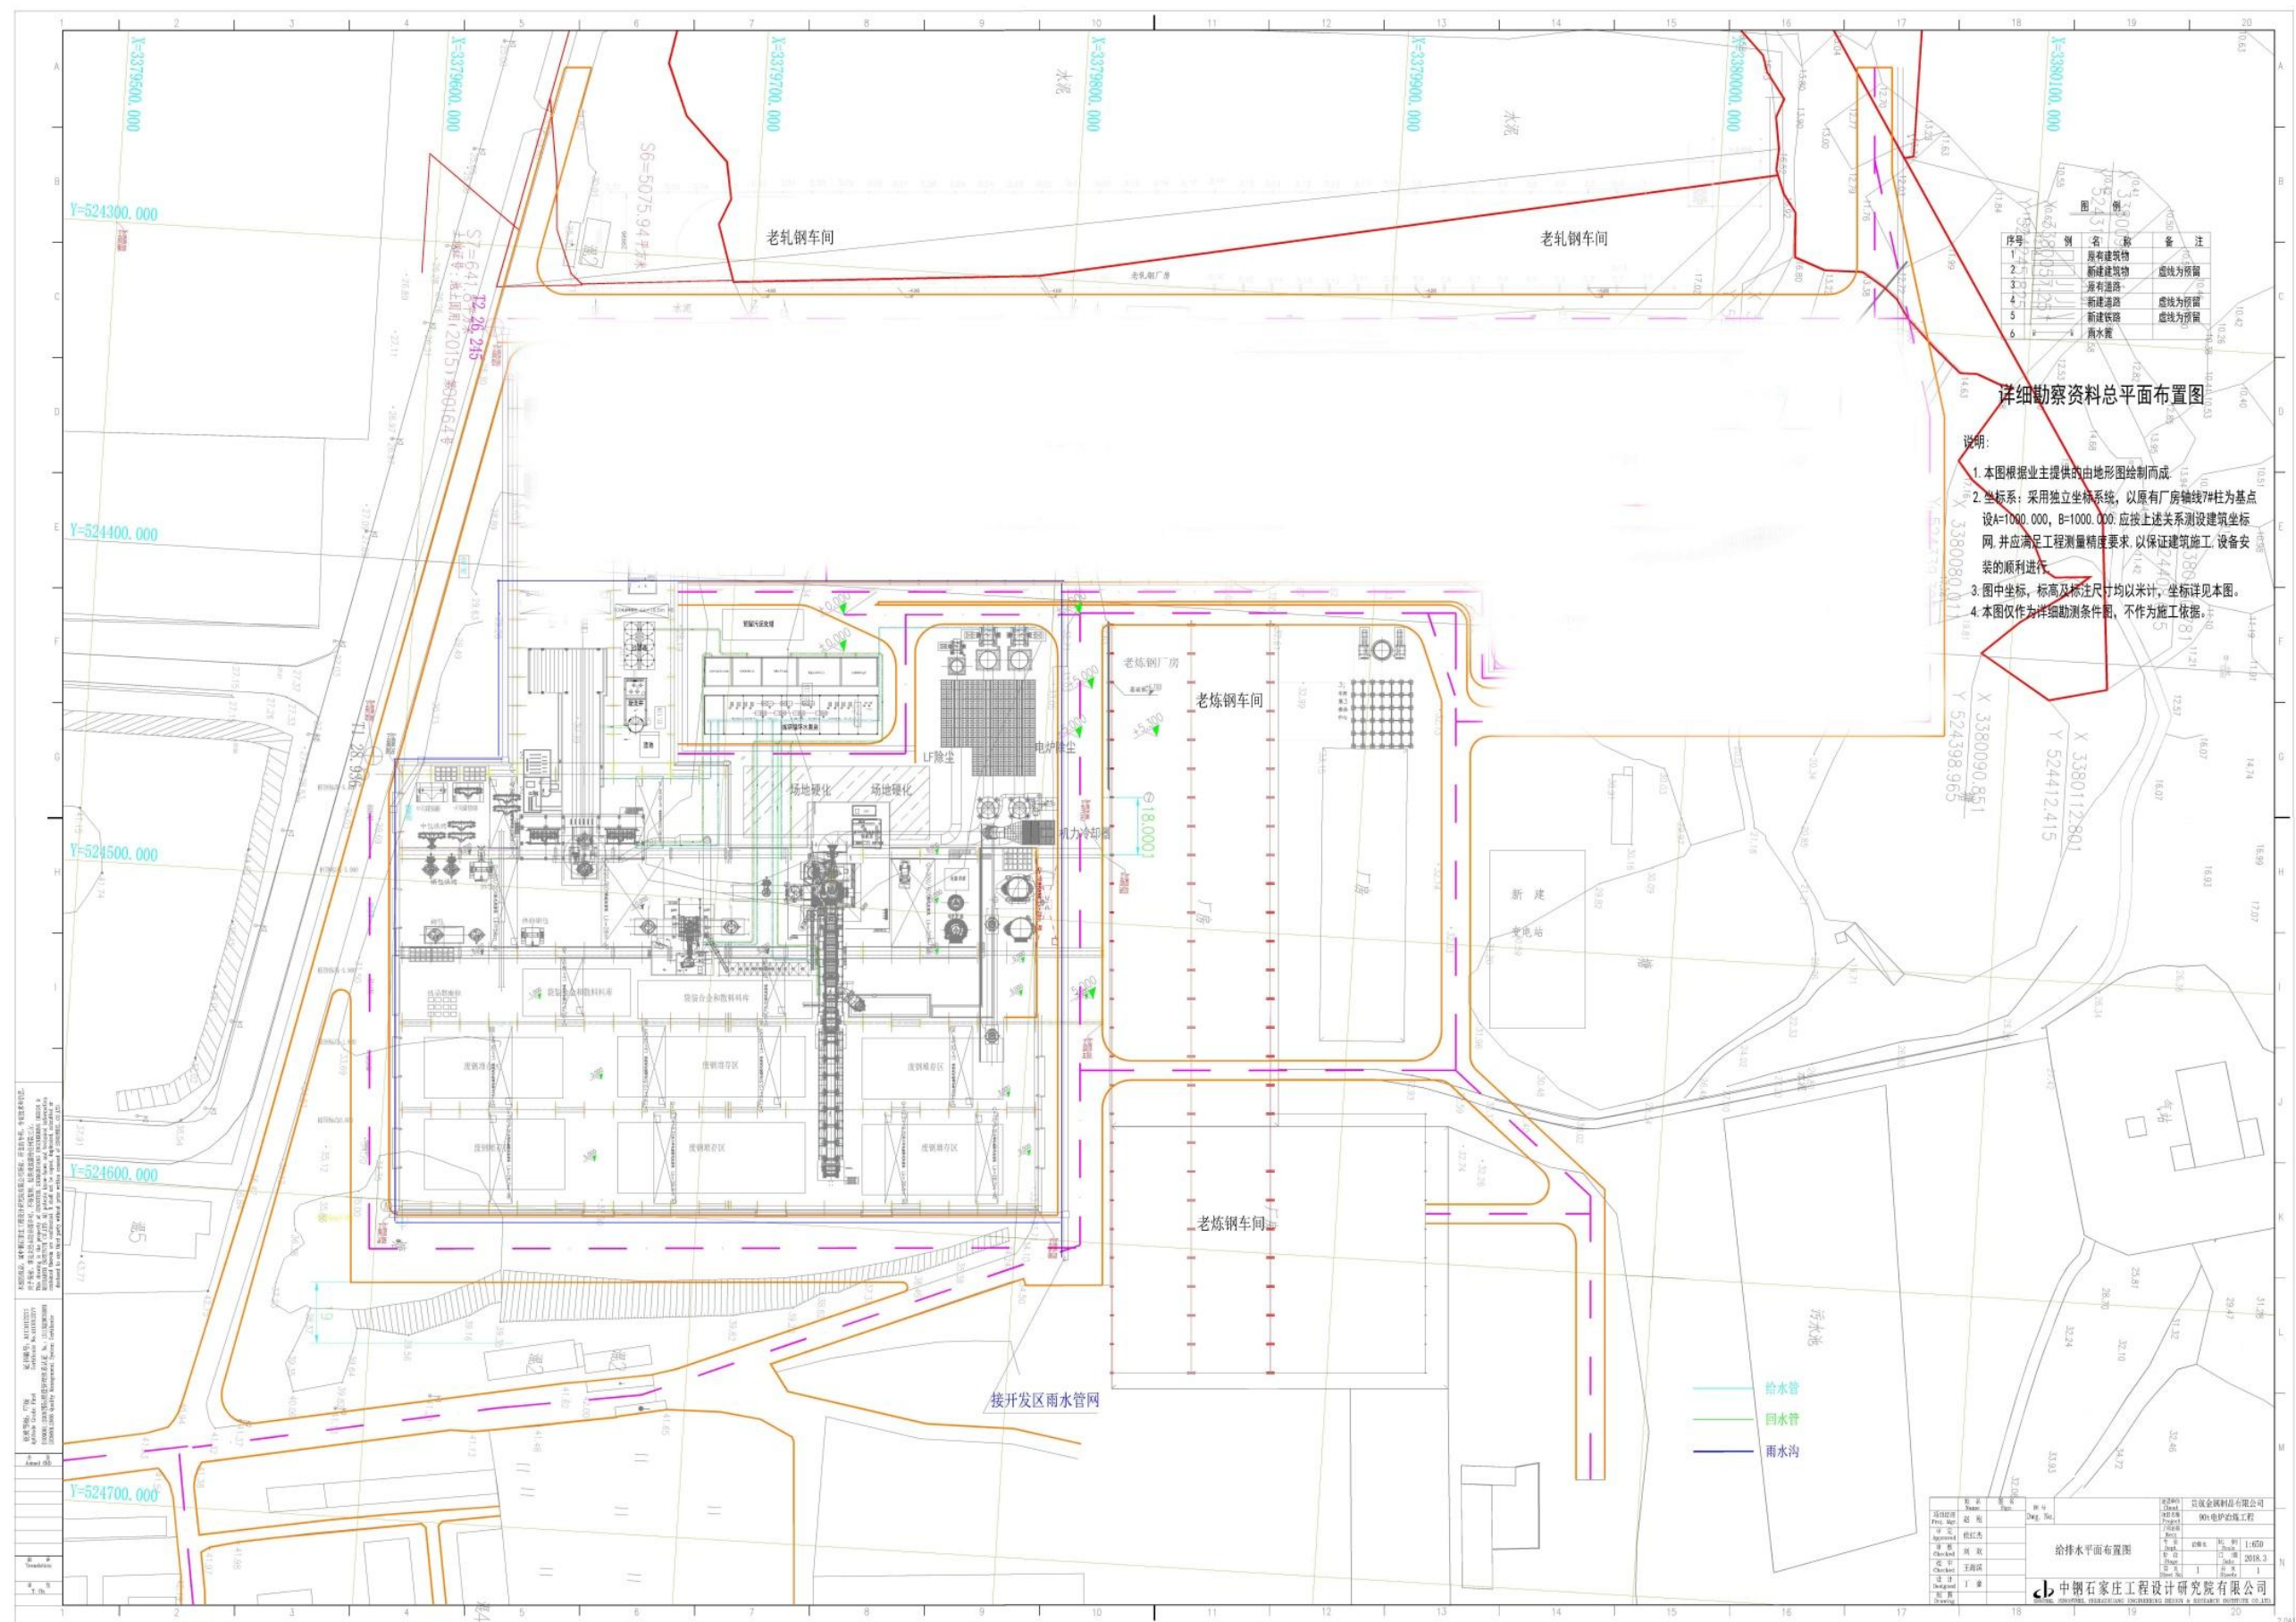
贵航金属制品公司技改项目全厂总平面布置示意图
